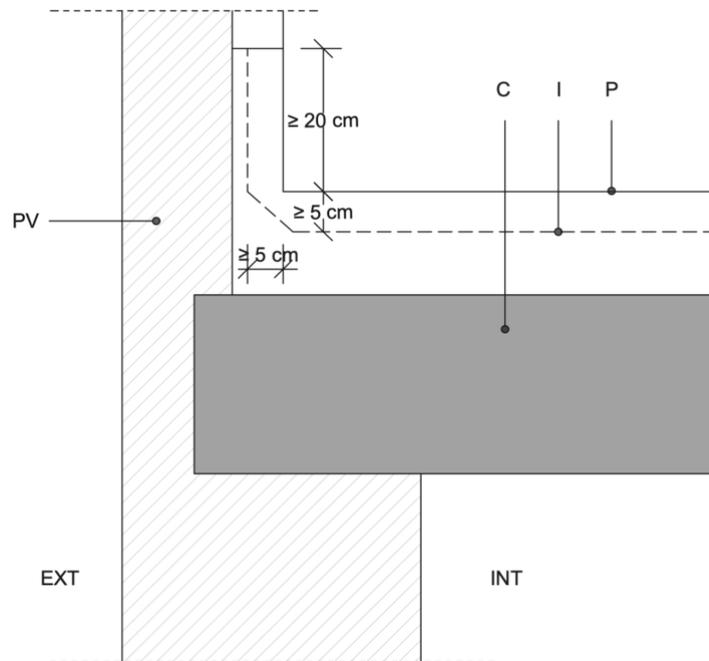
Encuentro con paramento vertical. Leyenda: PV Pavimento vertical; C Cubierta; I Impermeabilización; P Protección.
